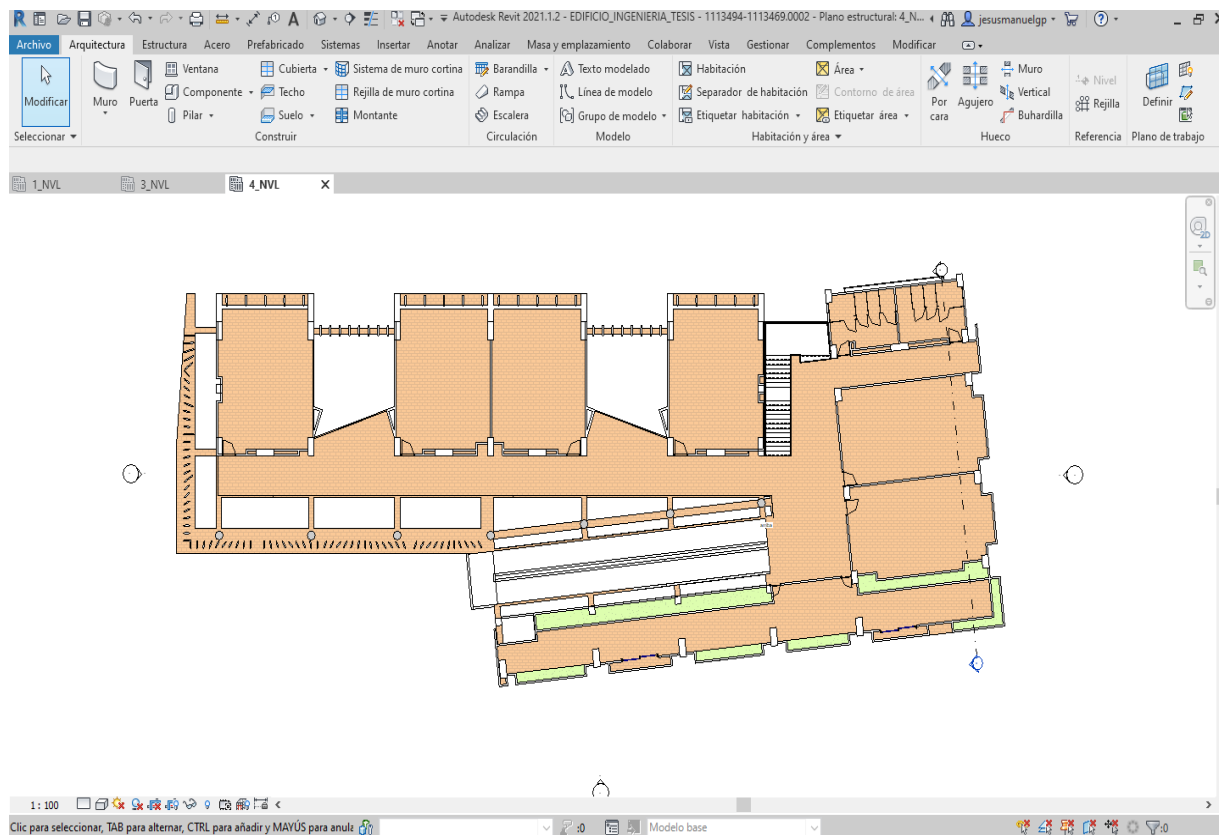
Importación de plano 2D plano estructural planta N°4 edificio aulas oriente.
